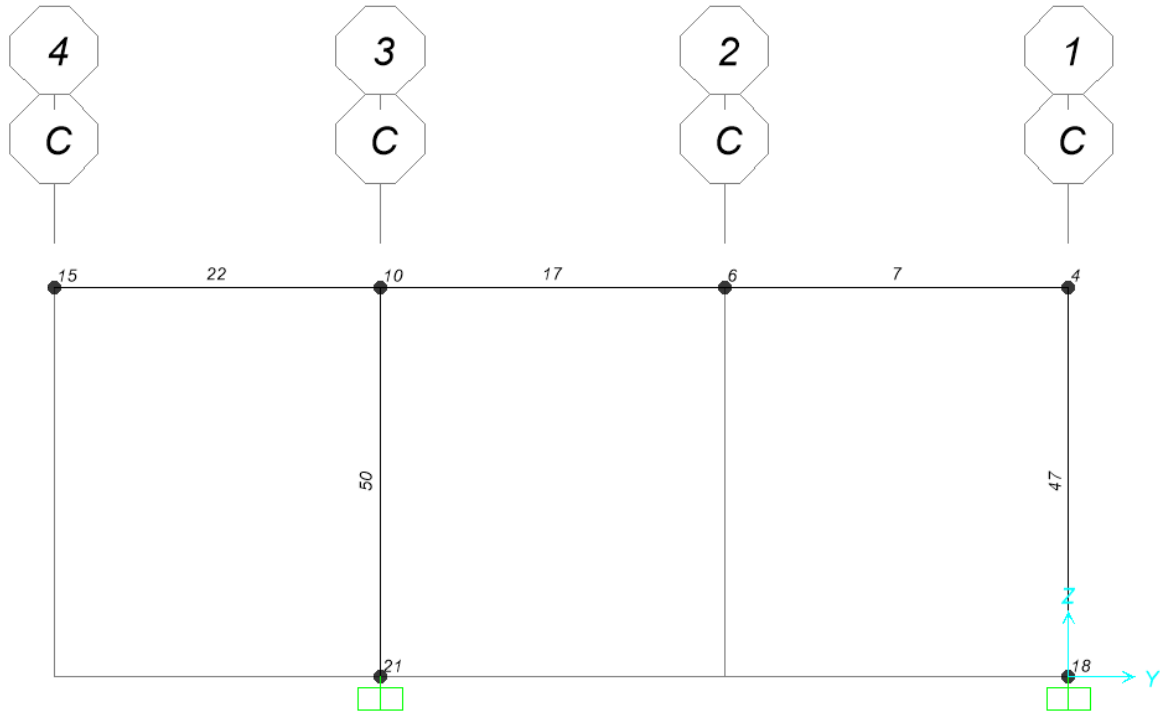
Vista in sezione modello struttura in elevazione –Filo C - numerazione elementi frame e joint
